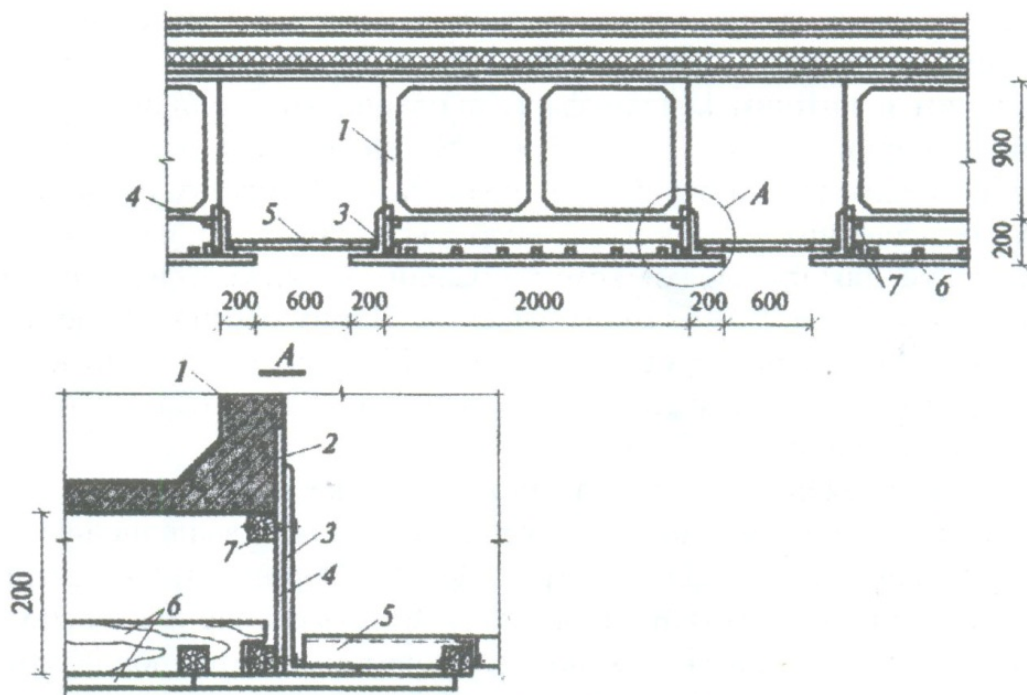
Перекрытия многоэтажных зданий с использованием коробчатого настила:
